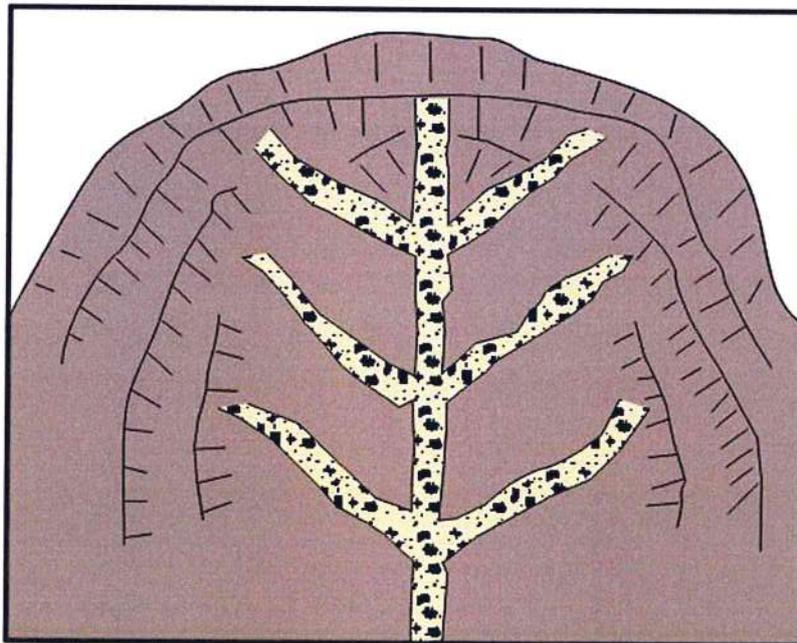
Drenaje tipo espina de pescado realizado por INGEMMET (2000).
